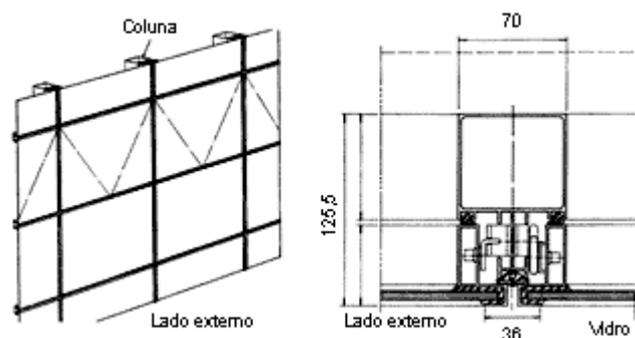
Fachada-cortina pele de vidro: as colunas da fachada são fixadas na viga pelo lado interno, mas o vidro continua encaixilhado
